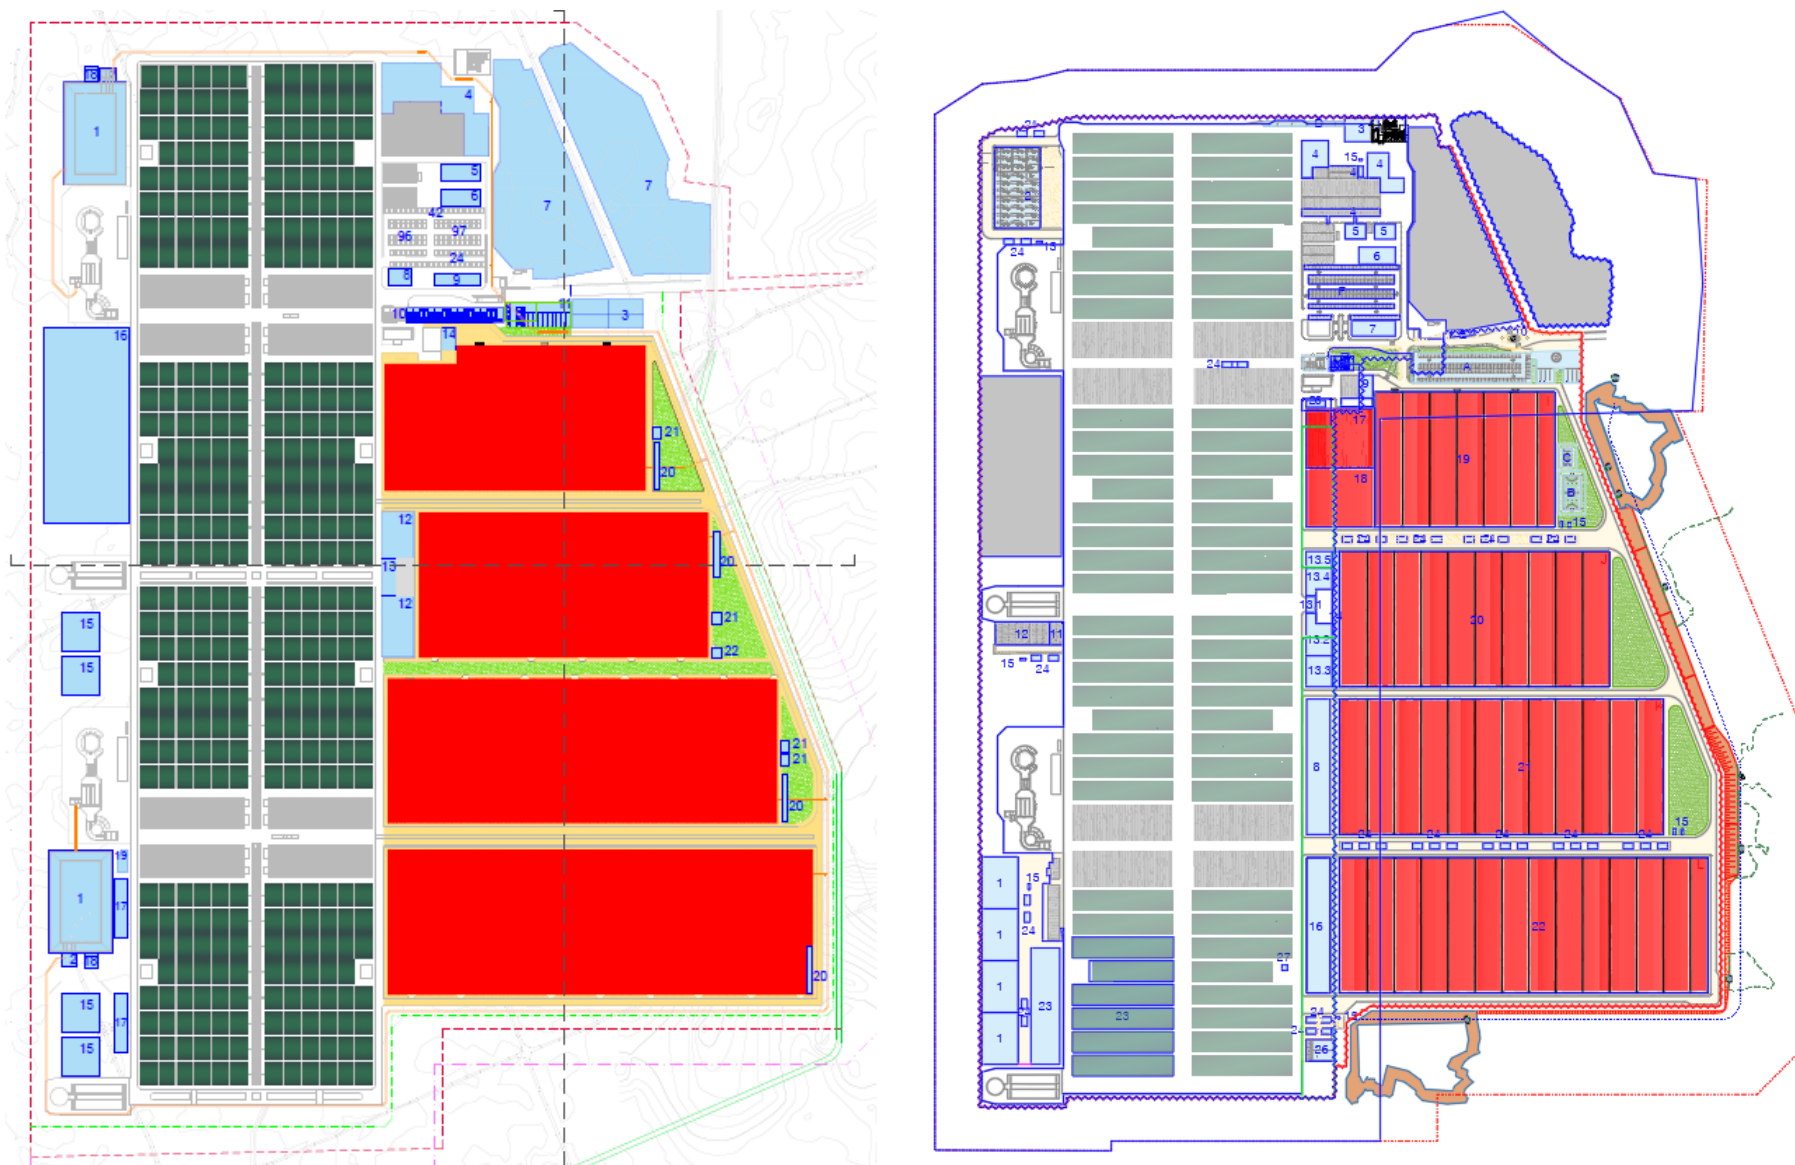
Alterações no desenvolvimento do estudo prévio e projeto de execução (A: Planta geral do estudo prévio; B: Planta geral do projeto de execução)
